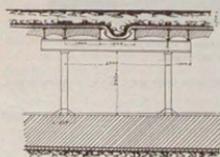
Ferrovia elevata e sotterranea di Berlino sezione longitudinale del tunnel.
